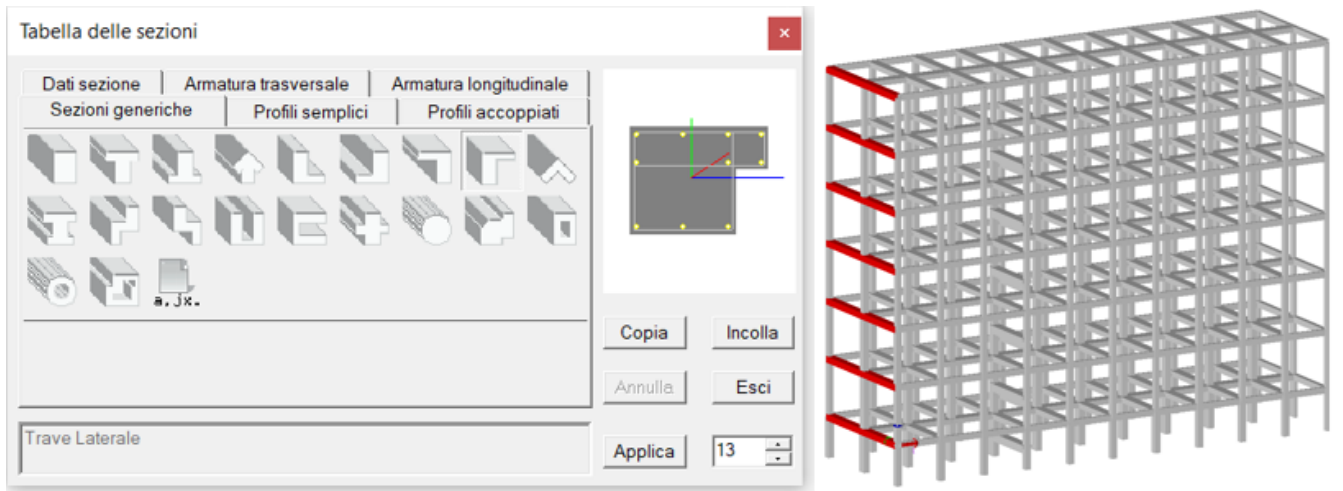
Modello US B1 - PROSAP, Archivio Sezioni, Proprietà n° 13 Trave Laterale, con inquadramento.
